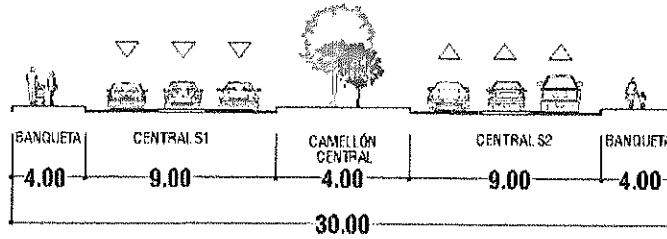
Estructura Vial y Conectividad. Fuente: Elaboración propia.
